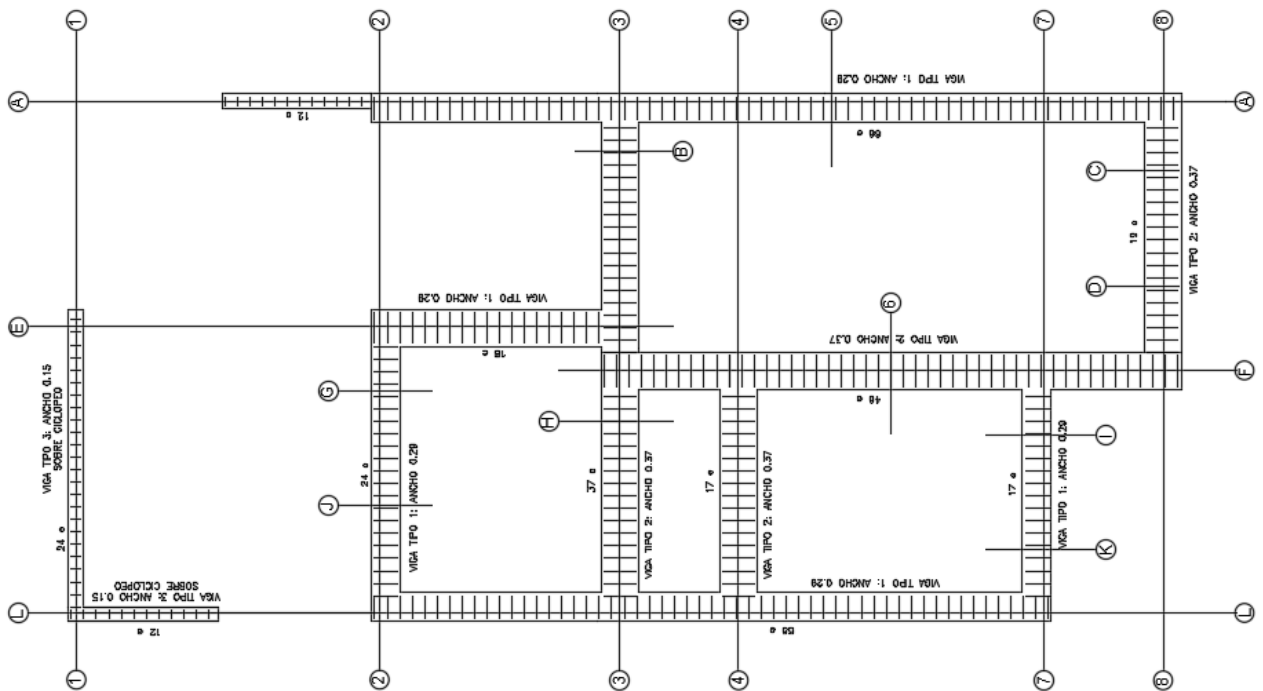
Planta refuerzo longitudinal vigas de cimentación y flejes vigas de cimentación
